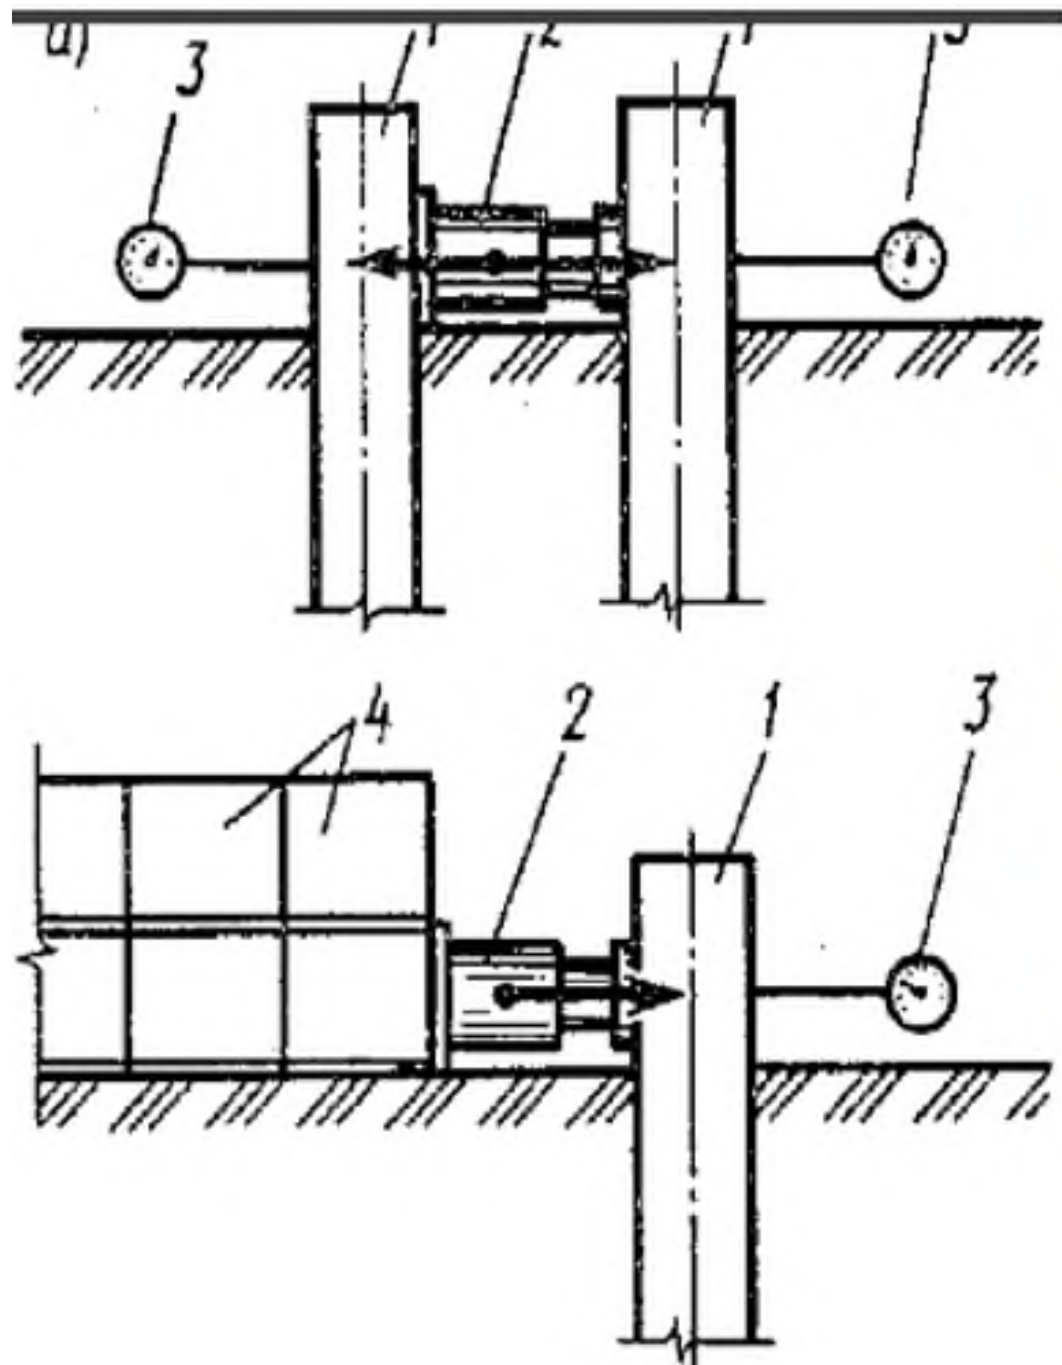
Испытания свай горизонтальной нагрузкой:
